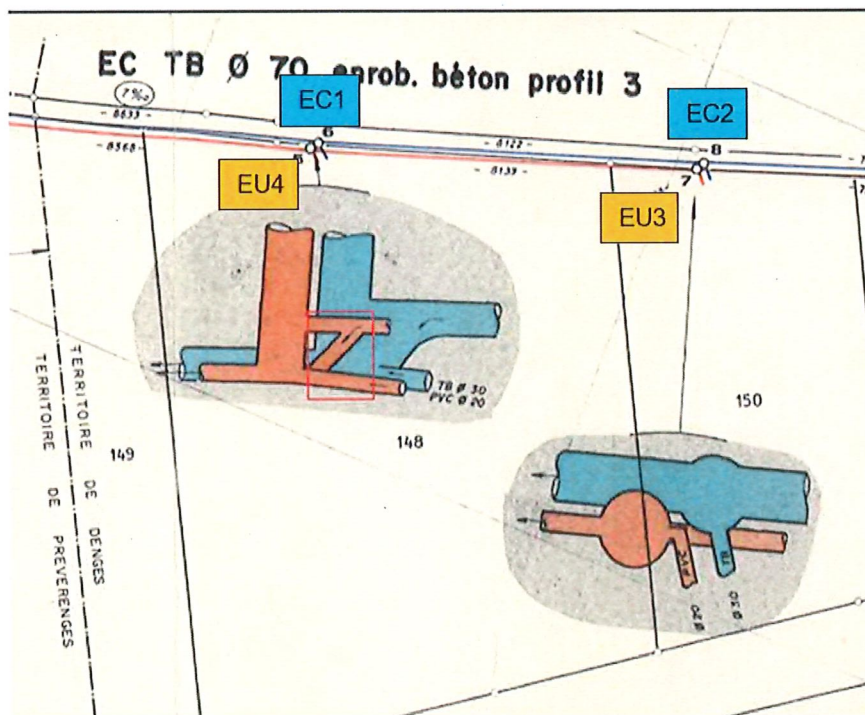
Extrait du plan des ouvrages exécutés (André Gueissaz et Bernard Biner, 1983).
